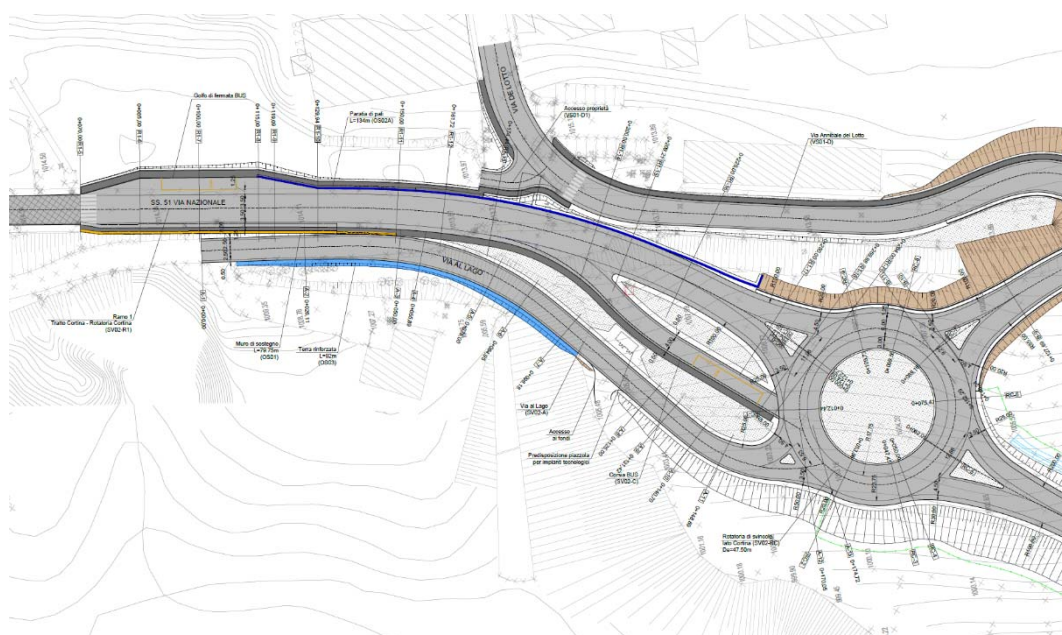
Stralcio planimetrico Ramo 1 del PE con fermate Bus
